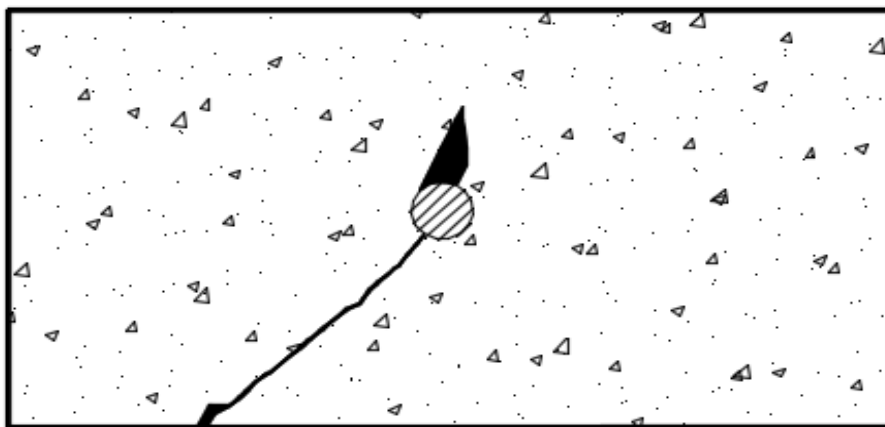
Fissura surgindo em elemento de concreto armado devido à corrosão da armadura. Fonte: adaptada de Helene (1986).
